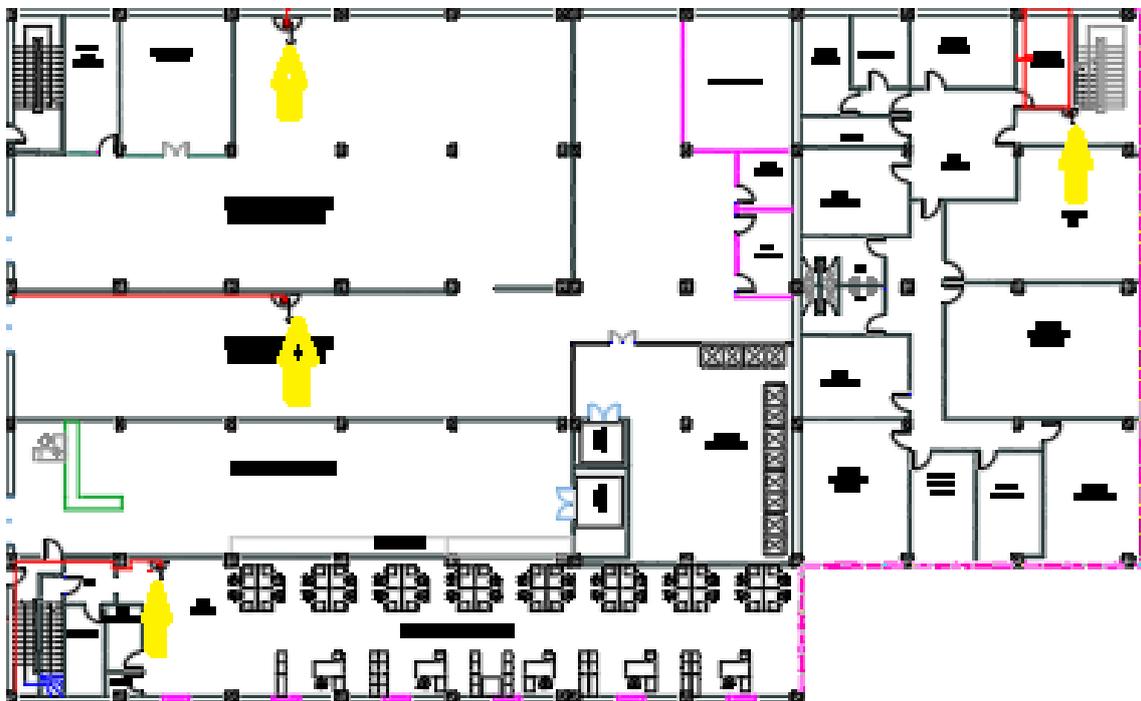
Représentation des RIA sur le plan du premier étage.
